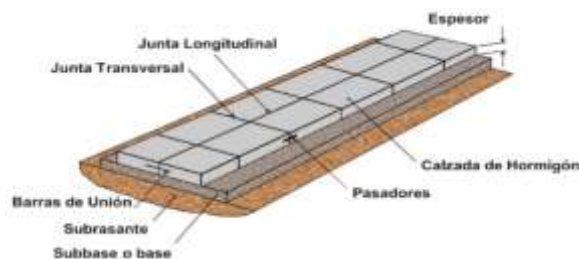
Disposición de juntas en una calzada. Fuente: (Rugosidad en pavimentos de hormigón. Influencia de la temperatura – Revista Vial, no date)
